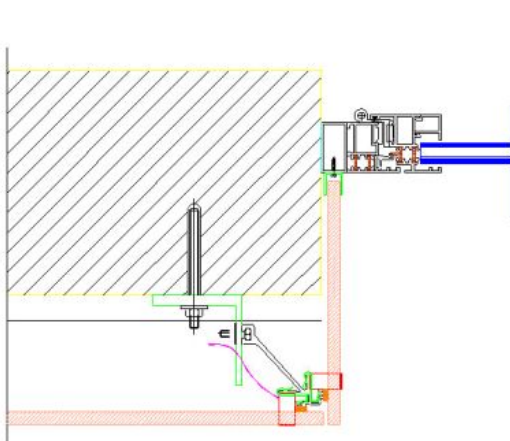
Aplicação da fachada ventilada – Remate da janela com sistema à vista [48]
